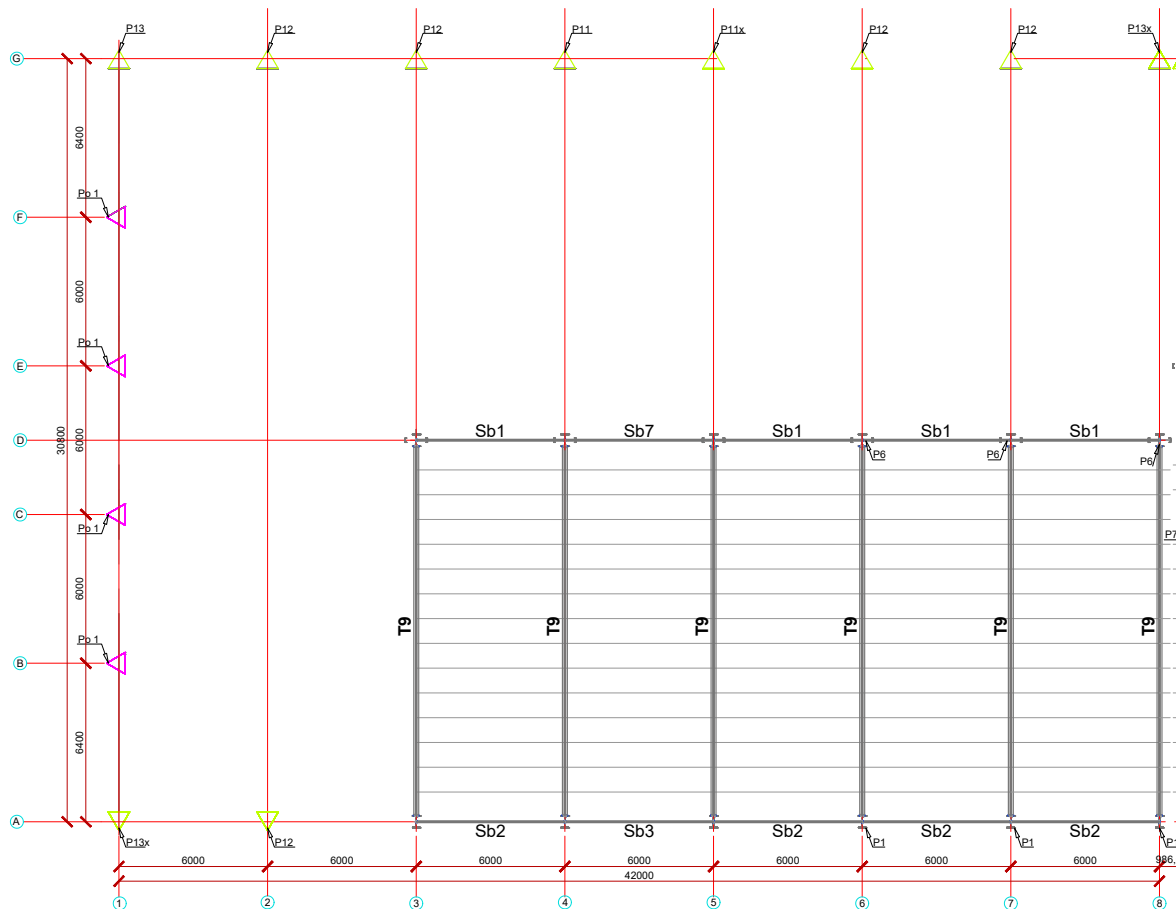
Vue en plan du Bloc A montrant l'organisation générale de la structure.
